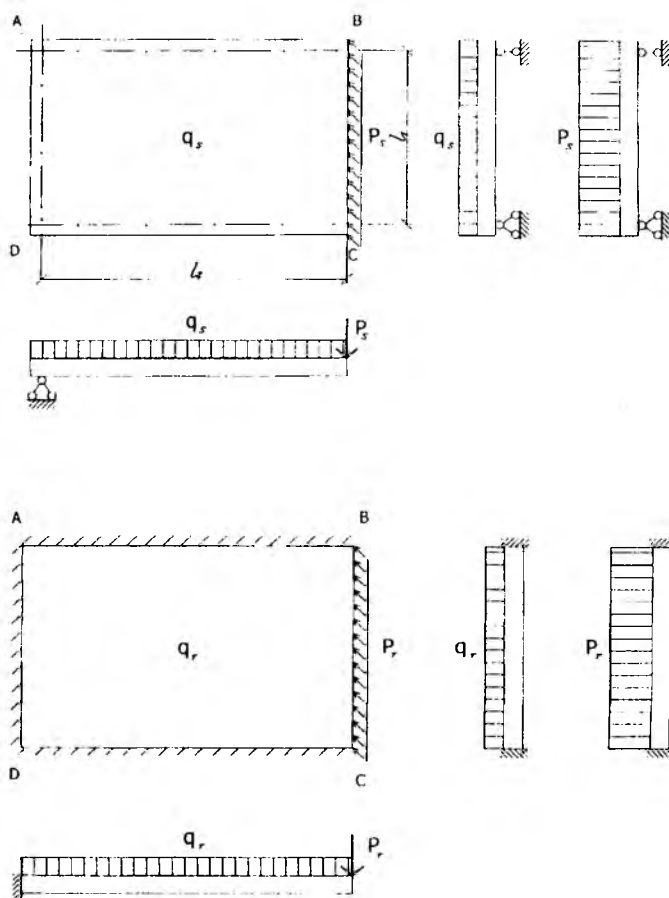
Расчетные схемы опорной по трем сторонам плиты с краевой нагрузкой от наружных стен (BC - свободный край)
